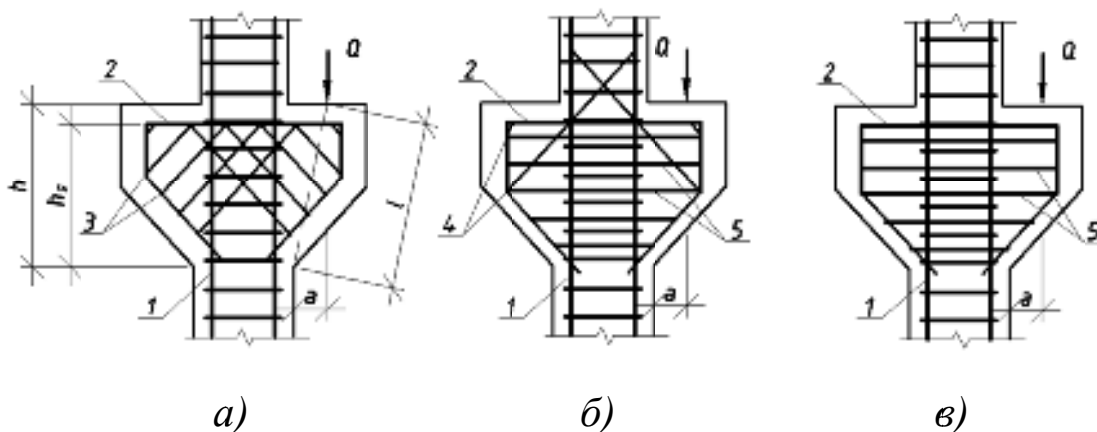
Схемы армирования консолей: 1 – каркас колонны; 2 – продольная арматура консоли; 3 – наклонные поперечные стержни; 4 – отгибы; 5 – горизонтальные поперечные стержни
